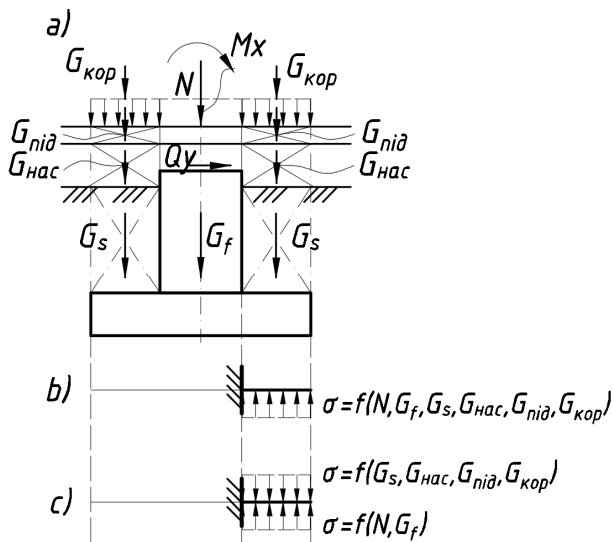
а) Сили, які діють на фундамент під середню колону; б) Ступінь фундаменту як консольна балка та напрямок дії на неї напруження (тиску) від дії всіх додаткових сил при перевірці розмірів фундаменту; в) Ступінь фундаменту як консольна балка та напрямок дії на неї напруження (тиску) від дії окремих додаткових сил при визначенні армування фундаменту.
